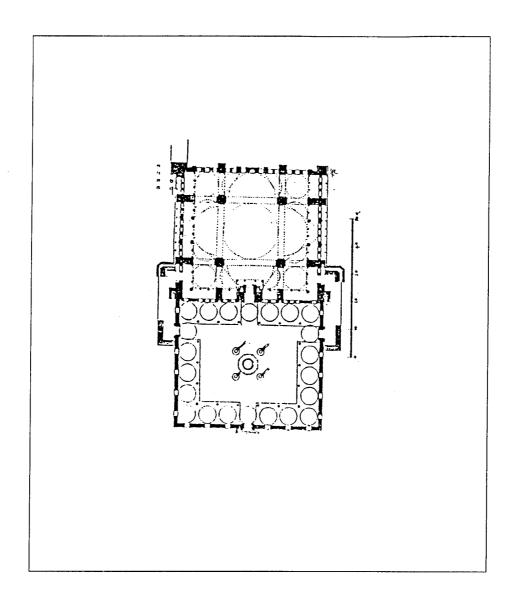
مسقط أفقي لمجمع شاهزاده في إستانبول (عن : اصلان ابا) .
